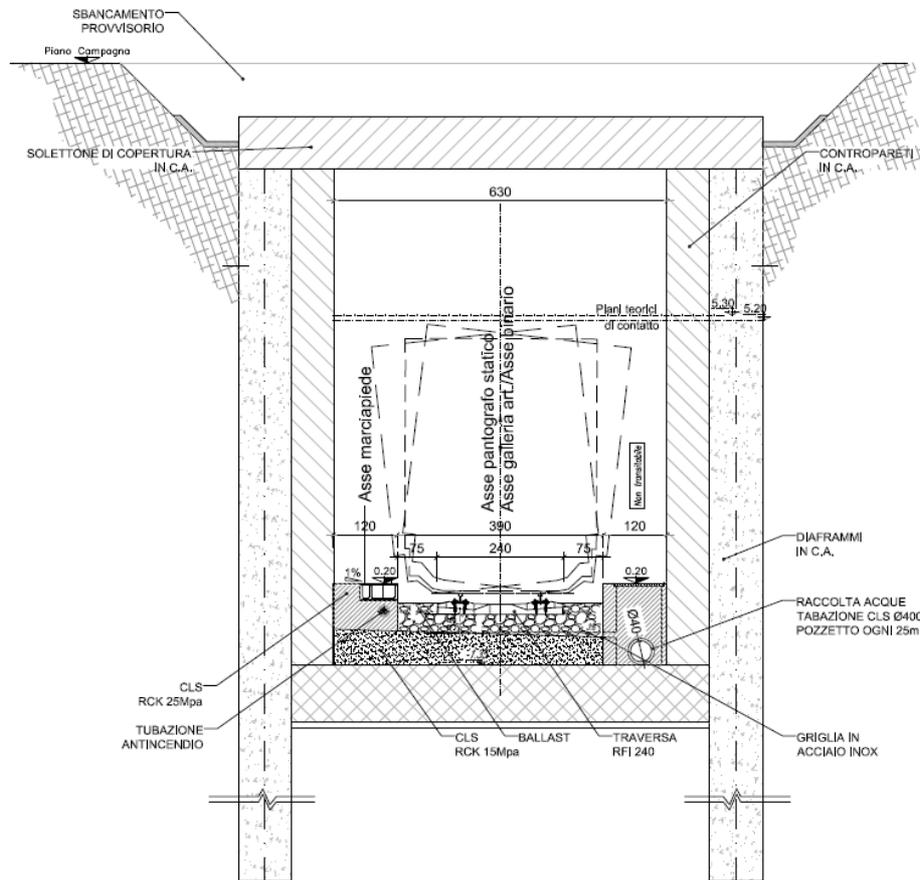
Sezione tipo Galleria artificiale (sezione tipo "2")
